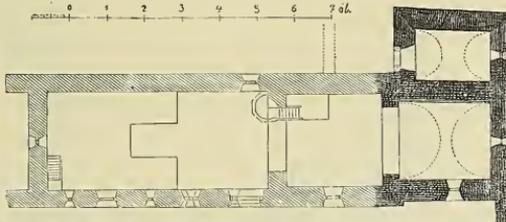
Grundriss der einstigen ev. ref. Kirche zu Nagy-Pécsel.
